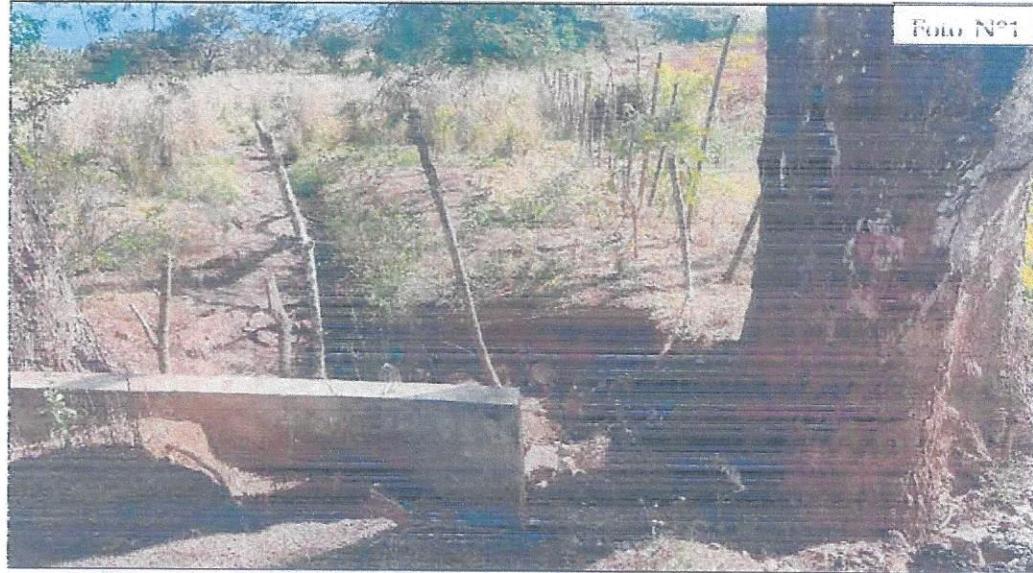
Se observa el canal pluvial ubicado hacia el este del polígono a desarroillar.
